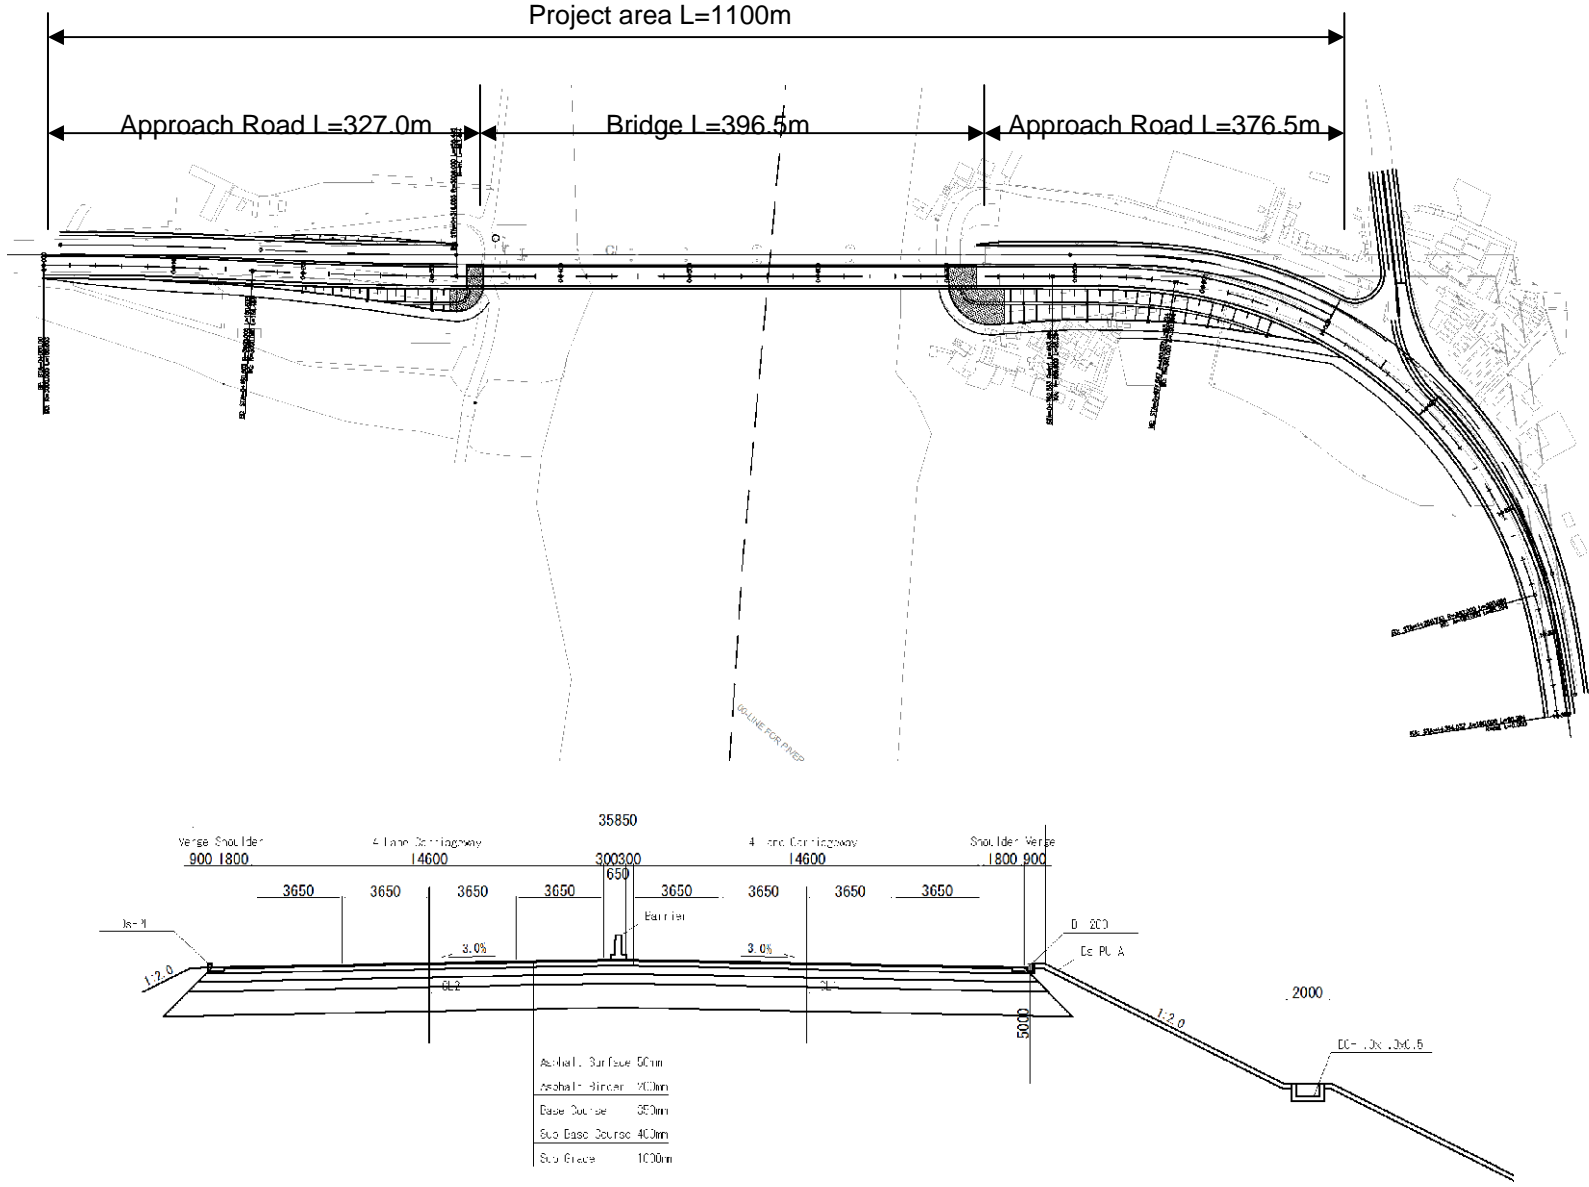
平面図、標準横断面図 (第2カチプール橋)
